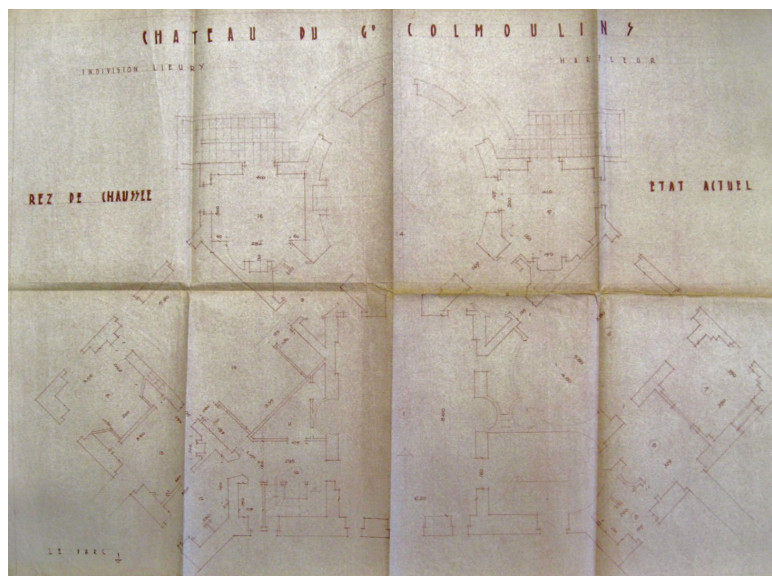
Plan du rez-de-chaussée pour la restauration du château de Colmoulin par l'architecte Loisel (1947). ADSM 238 W 4938
